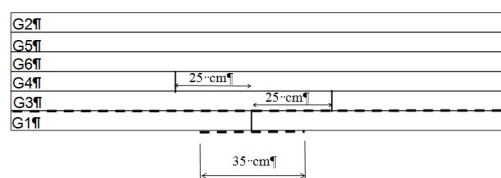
Vista lateral das vigas com reforço (linhas tracejadas)
